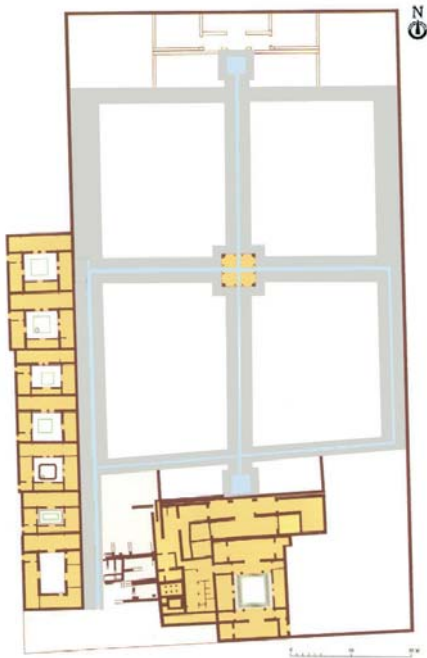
Dâr as-Sugrà, Murcia. Croquis de la planta (Pozo, Robles y Navarro, 2007a, fig. 2).
